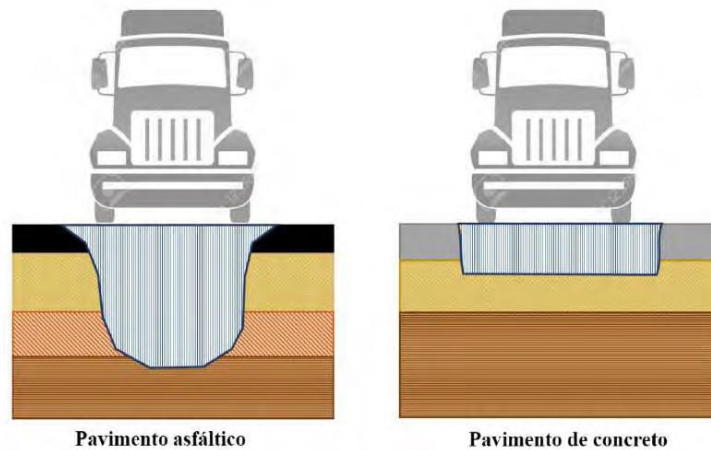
Distribución de esfuerzos desde la superficie hacia el suelo de cimentación en pavimento asfáltico y pavimento de concreto.
